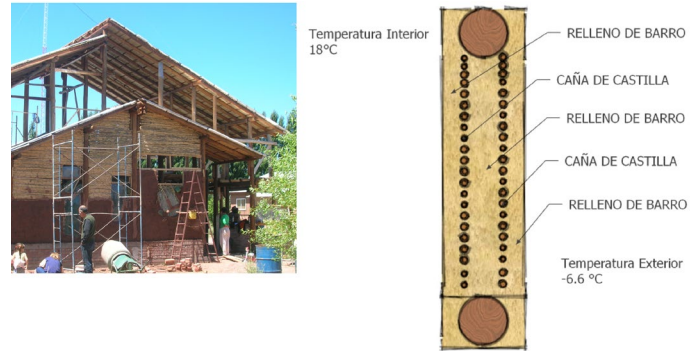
Eco Hostel Internacional de Malargüe, en la etapa de construcción. Fuente: Elaboración de los autores.
